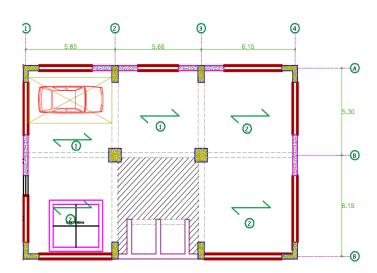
Plano estructural del 1º piso de la alternativa 01.
